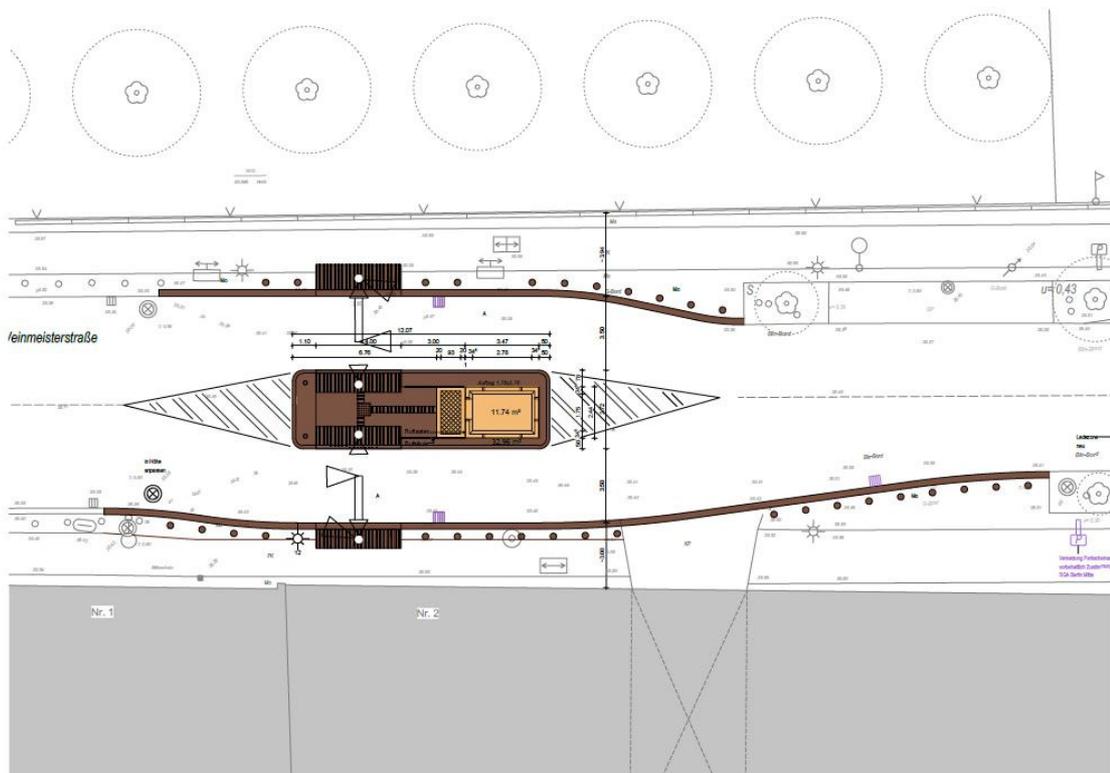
Instandhaltungsplan, Ausschnitt Plan W_PG004
